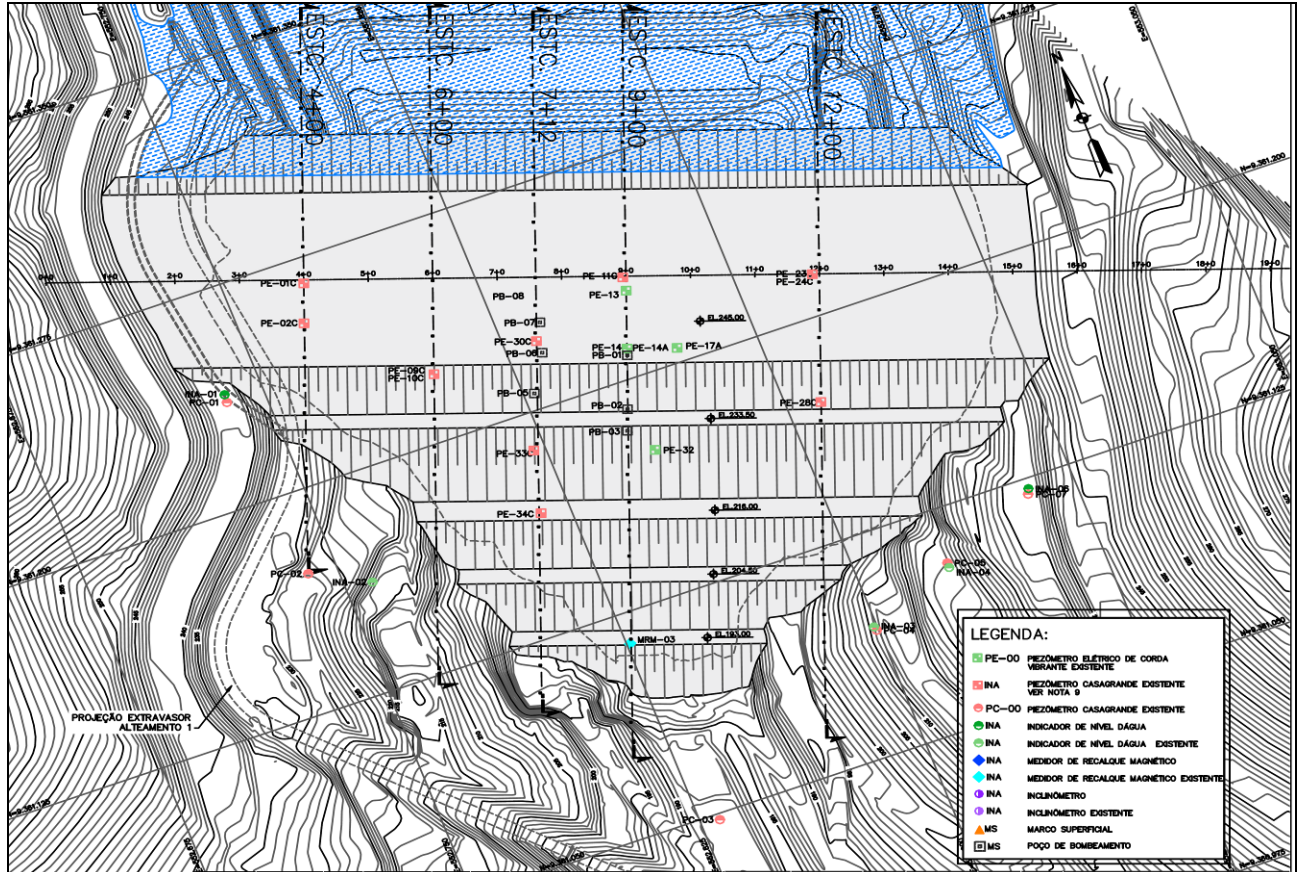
Planta de Locação das Seções de Análise e instrumentos já instalados
